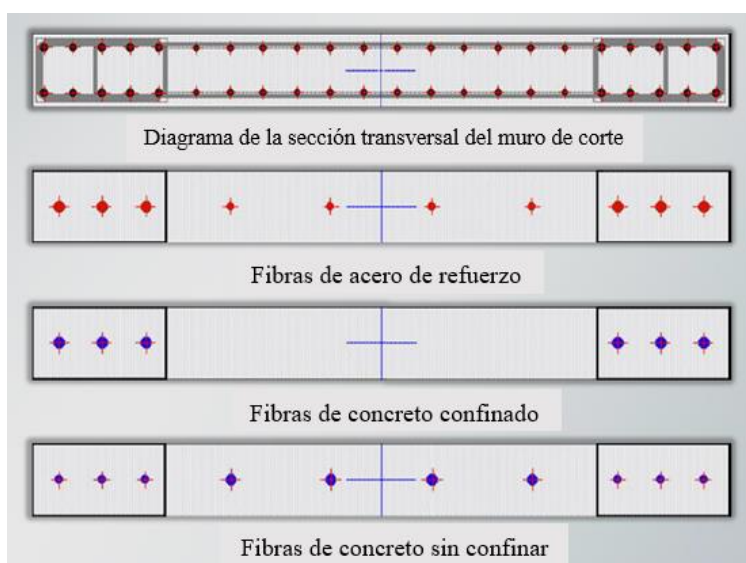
Discretización de la sección transversal de un muro de corte en fibras de concreto y acero
